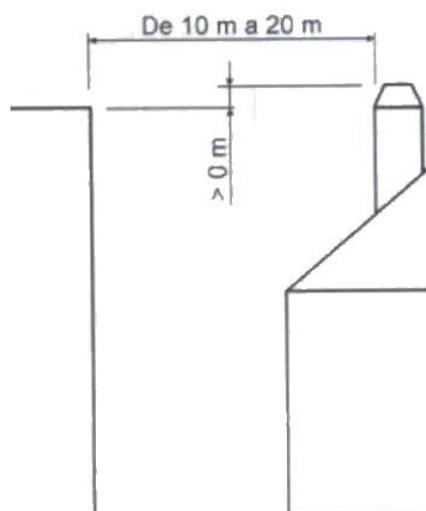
Distanza tra la finitura e oggetti tra 10 e 20 m
